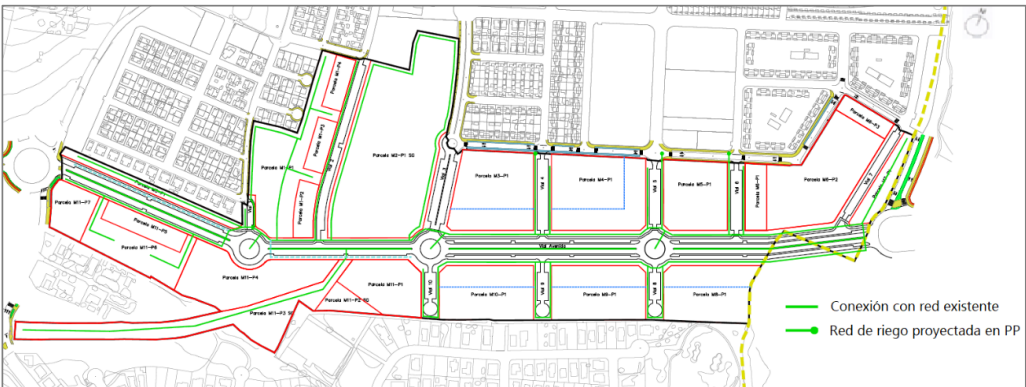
Red de riego. Fuente: Plan Parcial.
